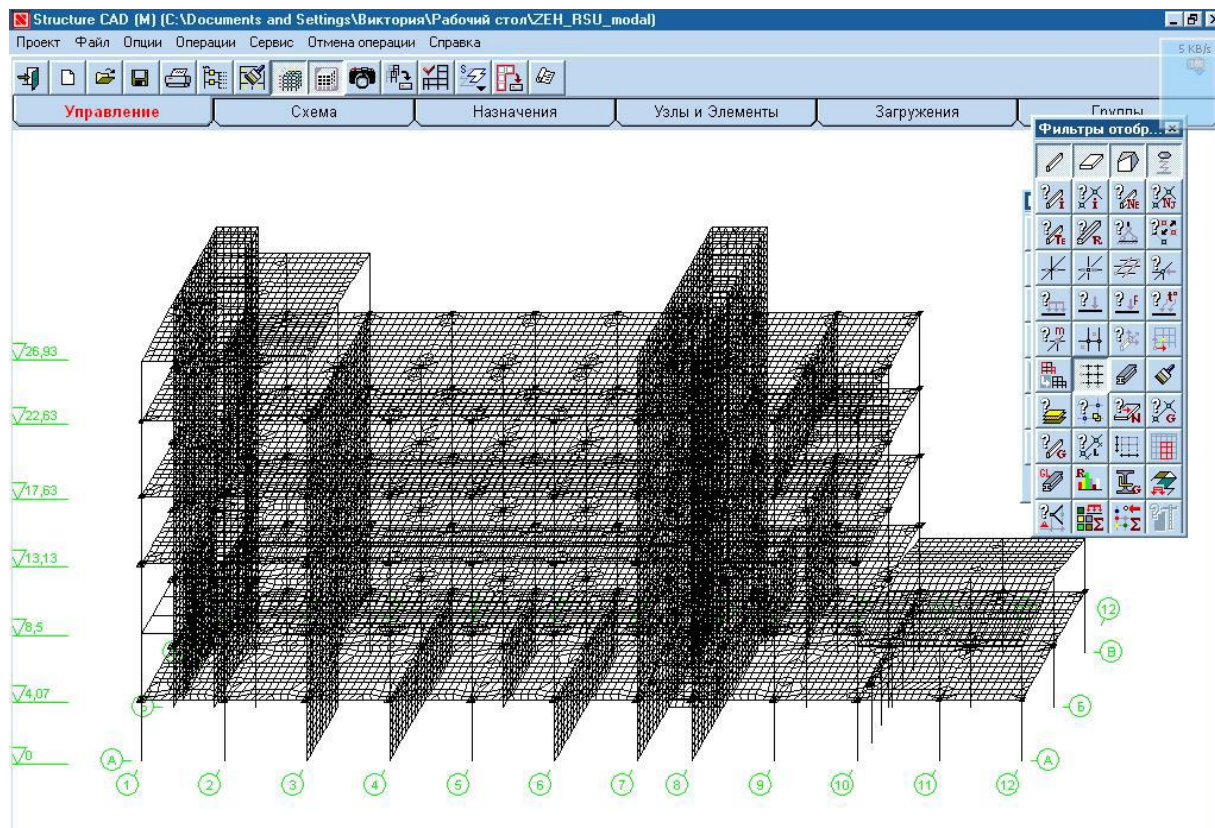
Кінцево-елементна модель каркасної будівлі
